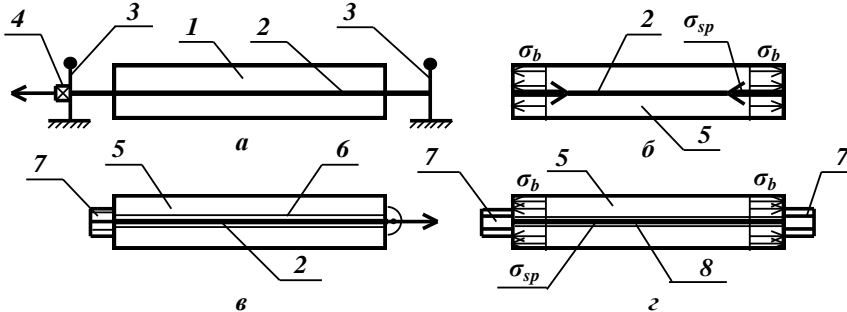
Способи виготовлення попередньо напружених залізобетонних конструкцій: *a* – натягання арматури на упори – принципова схема; *б* – готовий елемент; *в* – натягання арматури на бетон – принципова схема; *г* – готовий елемент; 1 – форма; 2 – арматура; 3 – упор; 4 – домкрат; 5 – затужавілий бетон; 6 – канал для пропуску арматури; 7 – анкер; 8 – канал, заповнений цементним розчином
